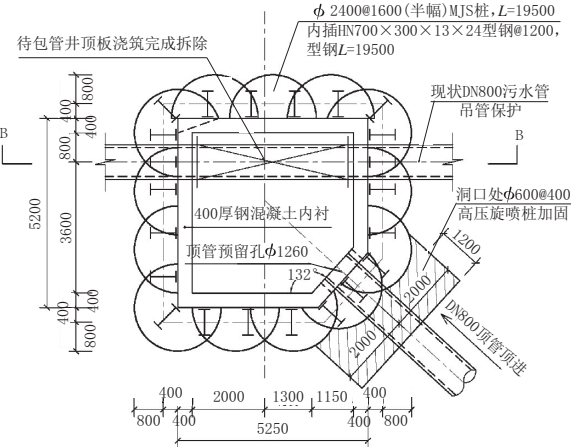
6b#包管井兼顶管接收井基坑平面图(单位:mm)
